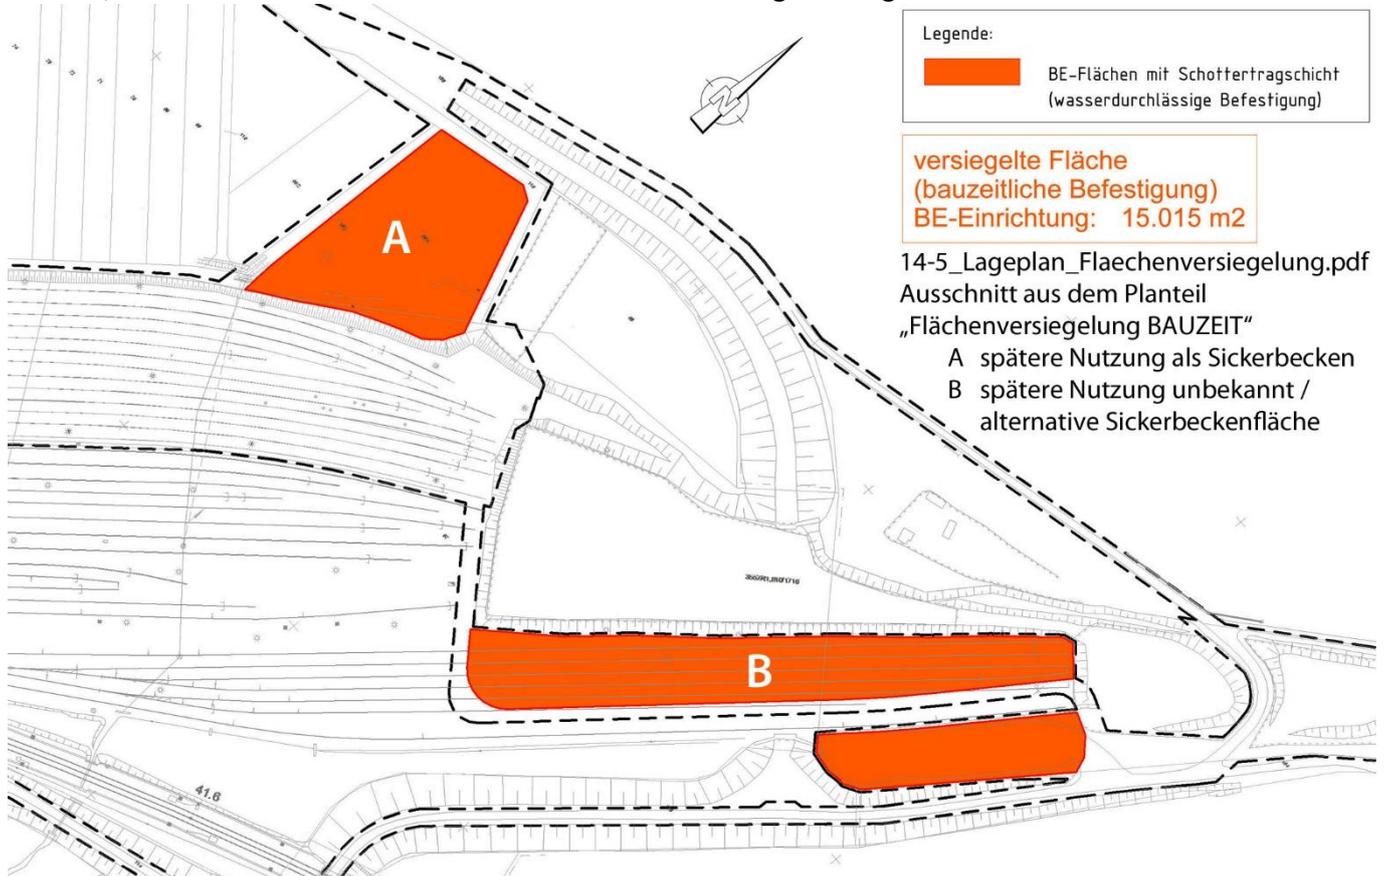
Ausschnitt aus Unterlage P14-5 mit ergänzter Legende und Erläuterung der Flächen A (geplantes Sickerbecken außerhalb des Bahngeländes) und B (Alternativstandort für eine Versickerungsanlage).
